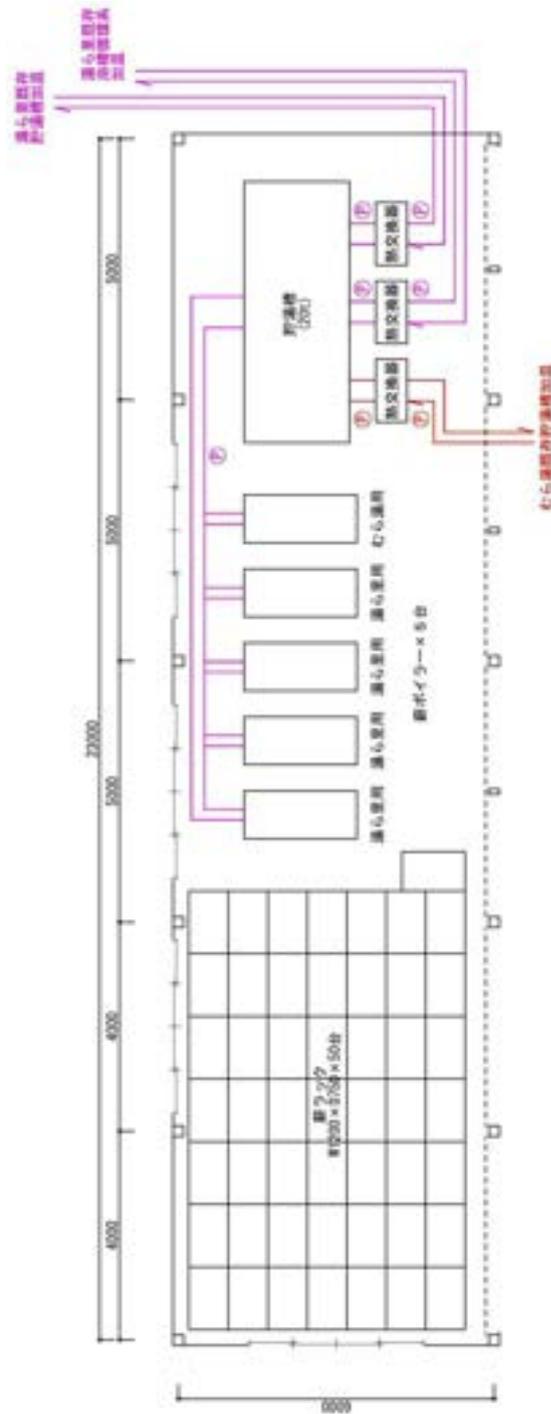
むら湯・湯ら里薪ボイラー棟 計画平面図
